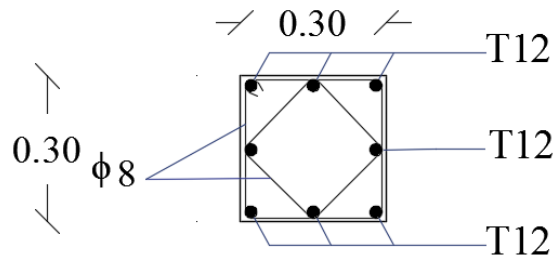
Ferrailage des poteaux bloc E1 & E2
